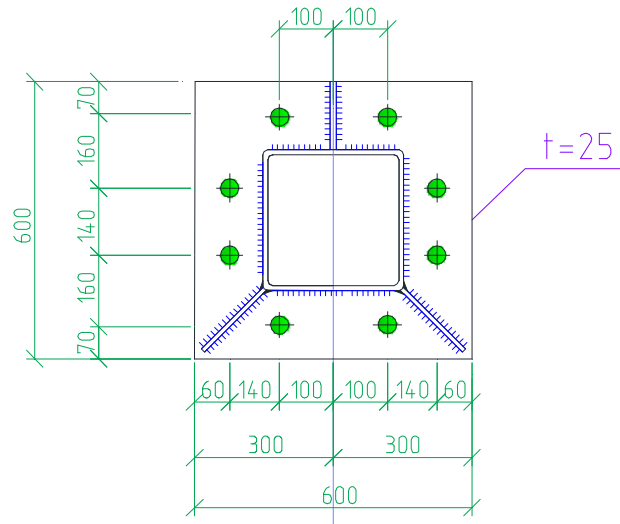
Фланцевое соединение нижнего пояса фермы
